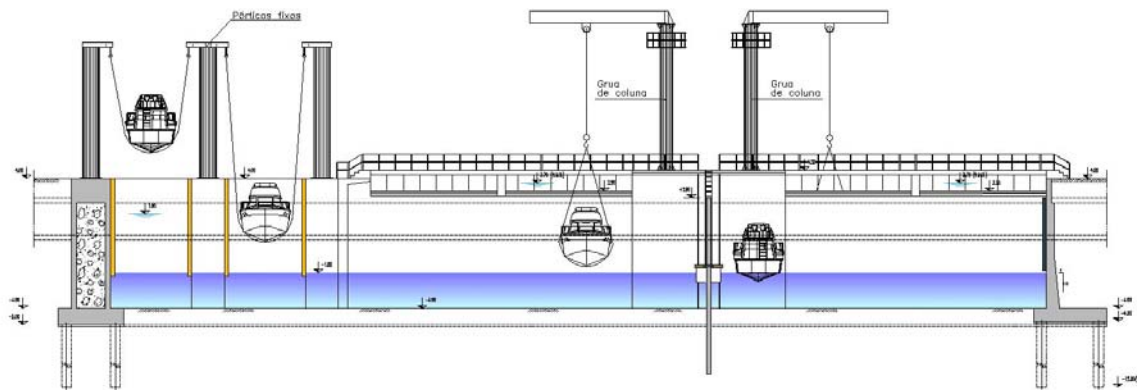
Sistema de transferência de embarcações. Alçado sul
